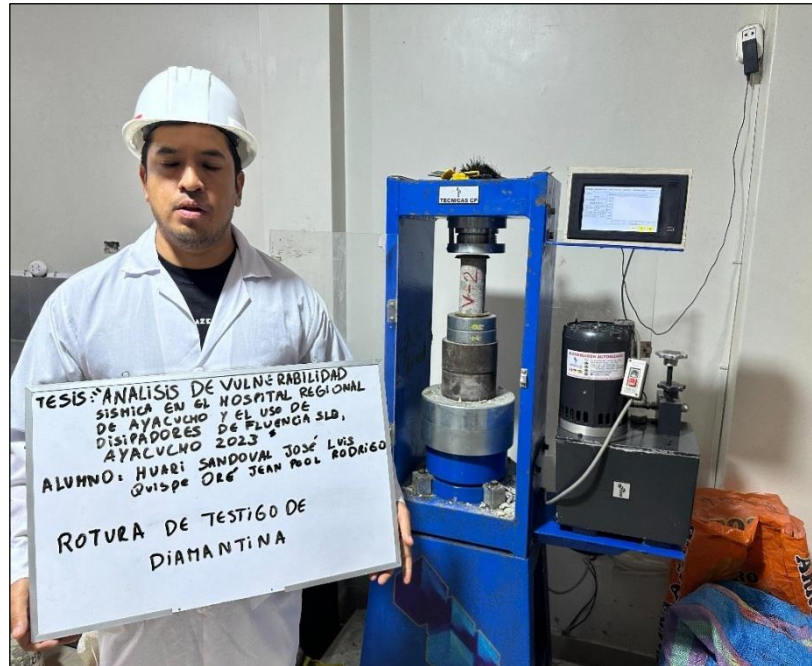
Determinación de resistencia a la compresión de testigos de viga.
